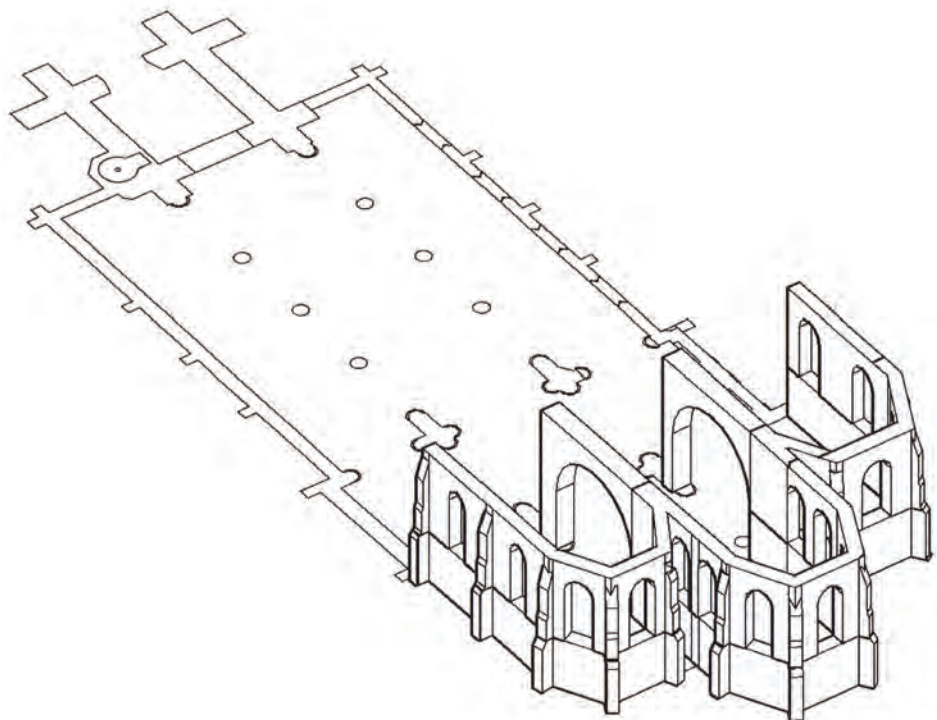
Houtem, O.L.Vrouwekerk, reconstructie van het 13de-eeuwse hallenkoor.
